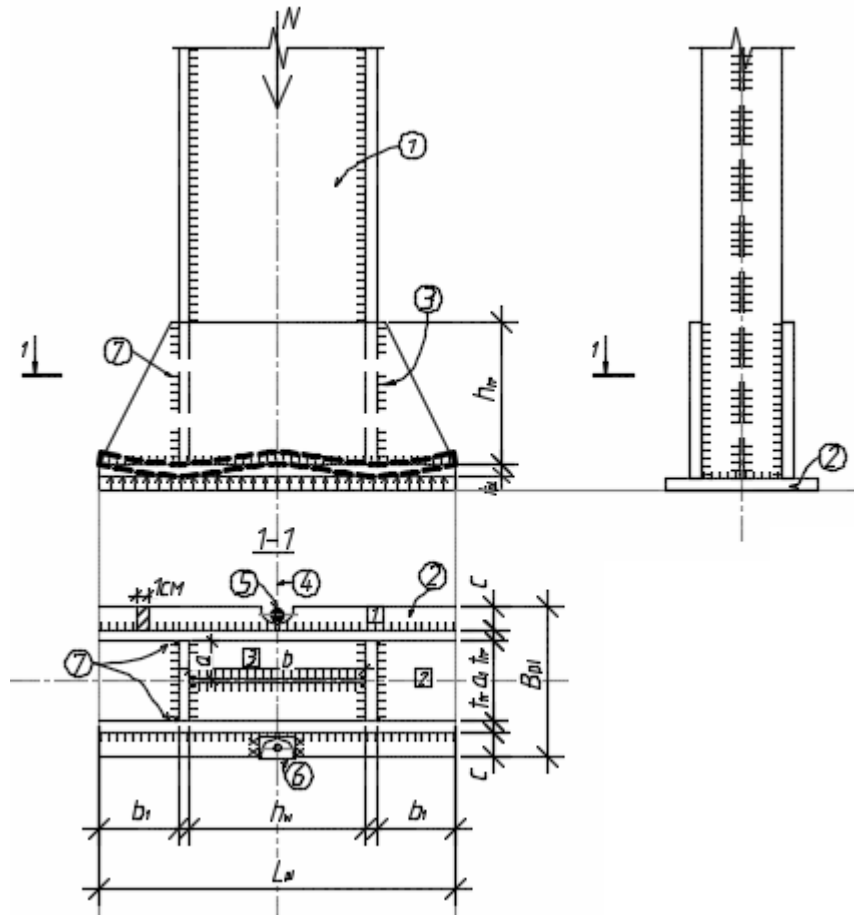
База конструкції сталевій колони з листовими траверсами [2–4]: 1– стержень колони (суцільний, складений); 2 – опорна плита; 3 – траверси (листові); 4 – осі анкерних болтів; 5 – прорізи у плиті для встановлення анкерних болтів; 6 – анкерна шайба; 7 – зварні шви, що кріплять траверси до колони
